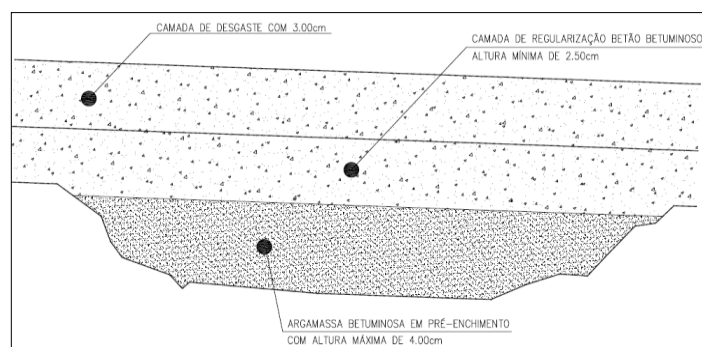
ESQUEMA DA ESTRATÉGIA DE PAVIMENTAÇÃO ADOTADA
